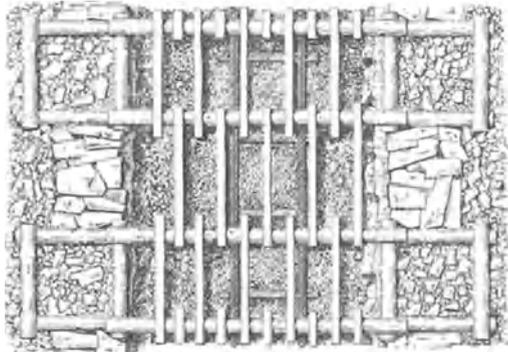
Firstenbänke auf Holzpfelern, mit Verzug (Druckschicht).
